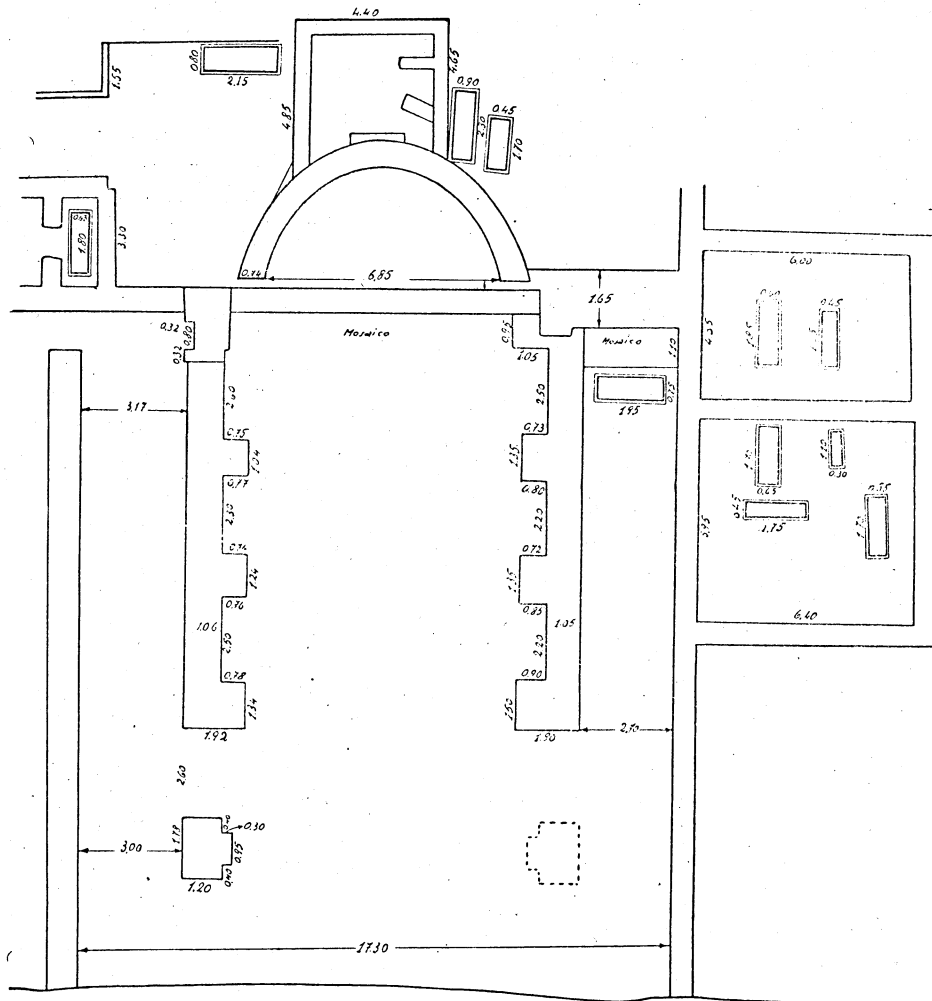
Scavi presso la Chiesa della Madonna di Siponto. Schizzo Planimetrico.
